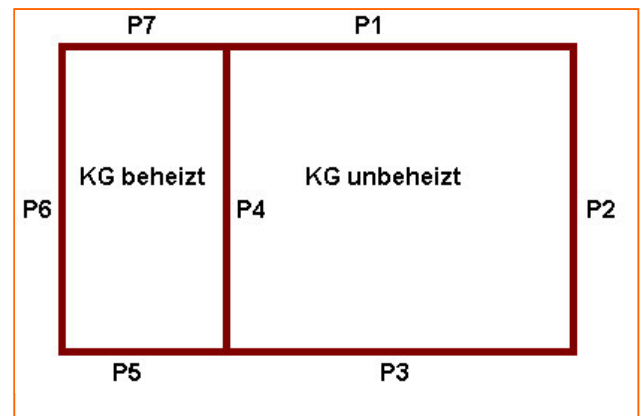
Anteile P am Gesamtumfang eines Kellers (Grundriss).
